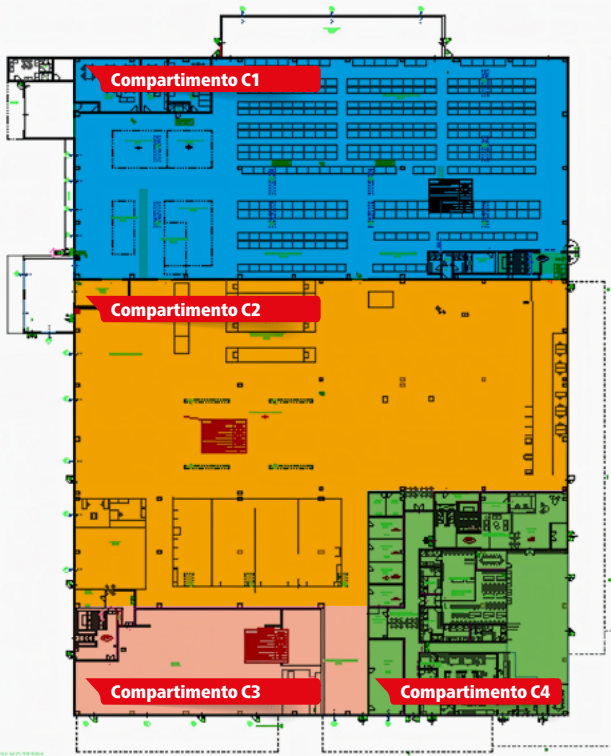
| Planimetria del piano terra e individuazione dei compartimenti
